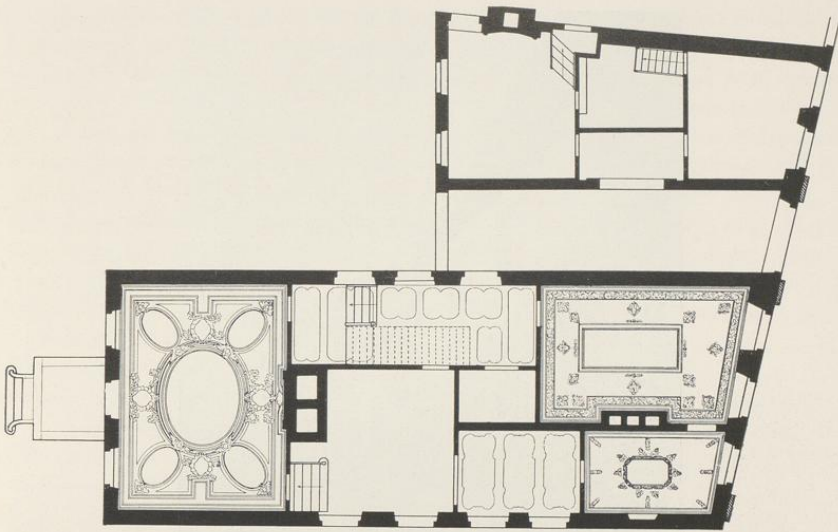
Grundriß des Erdgeschosses des Hofes Königstraße 39, Norden oben; die Ludgerstraße rechts
